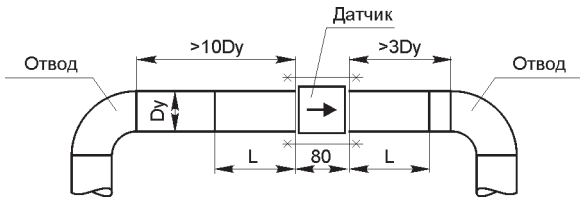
Установка в газопровод (паропровод) с отводом 90°.
